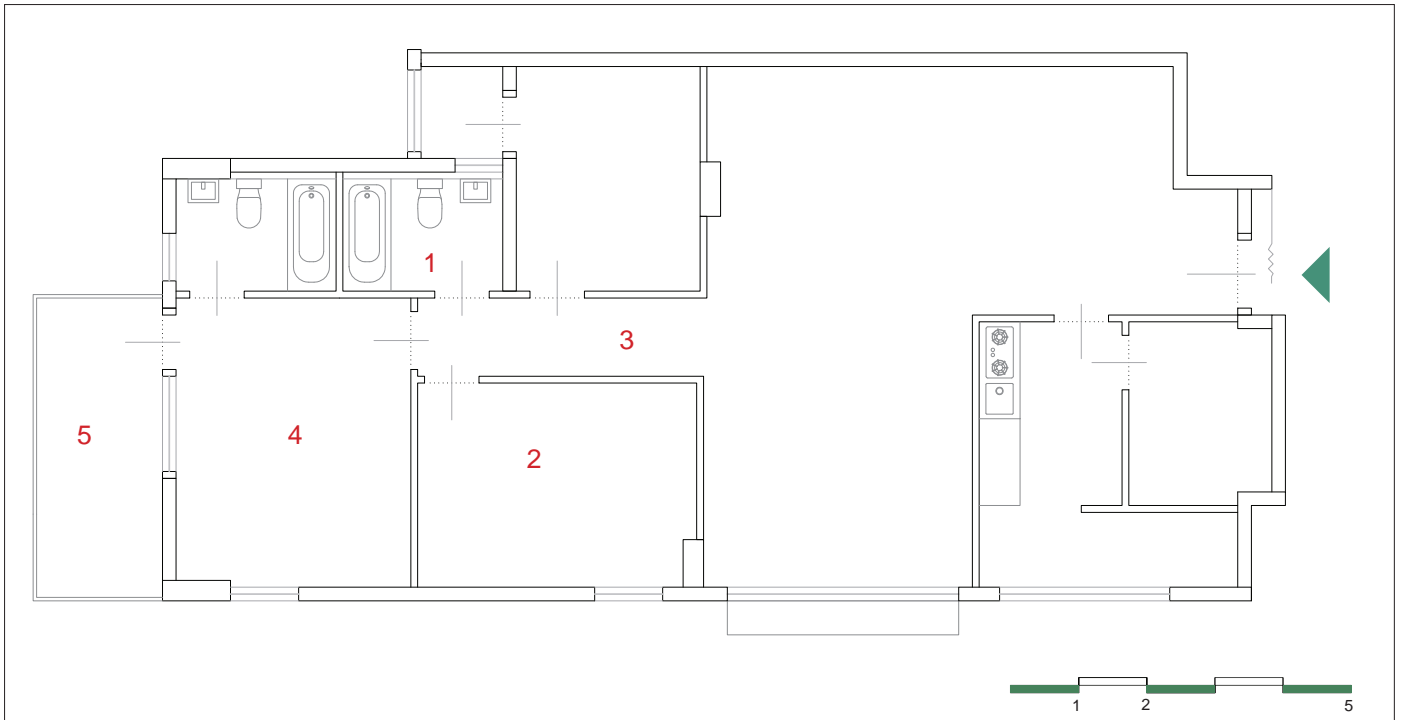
Wohnungsgrundriss - Mei Foo Sun
